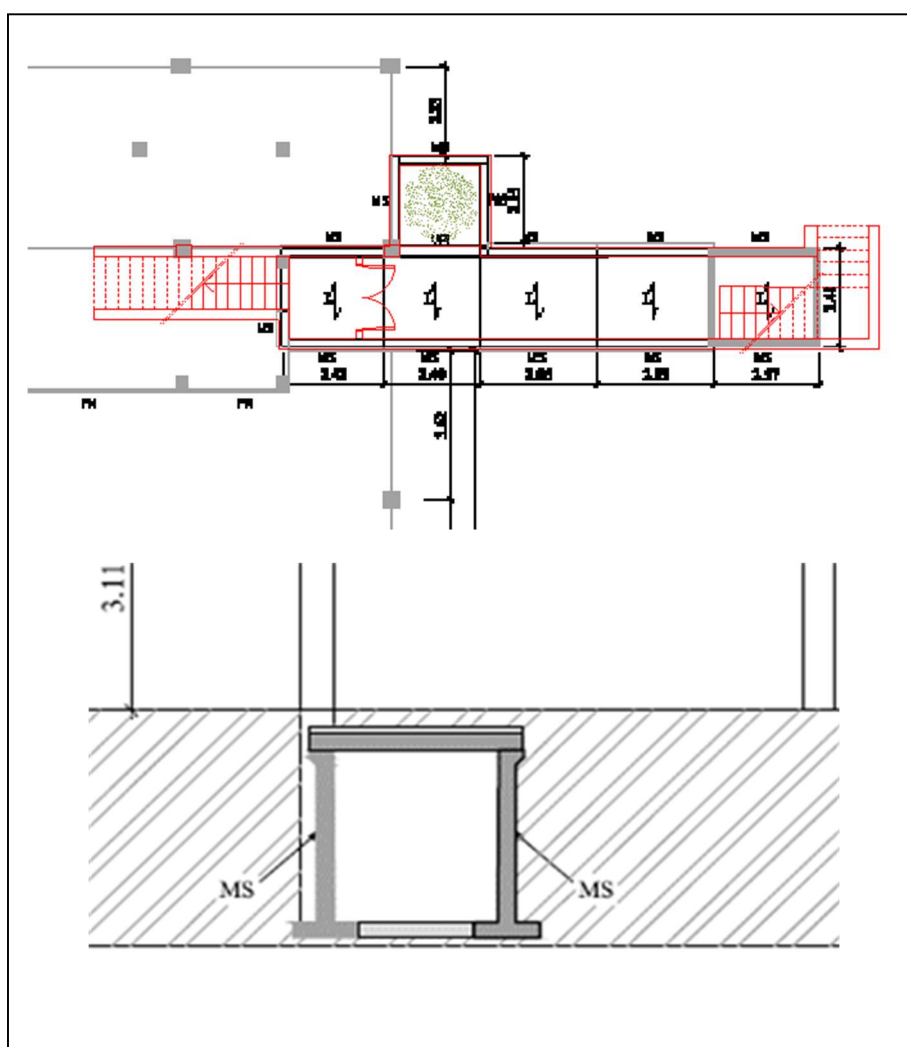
Planta sobreposta e corte do túnel com elementos pré-fabricados
